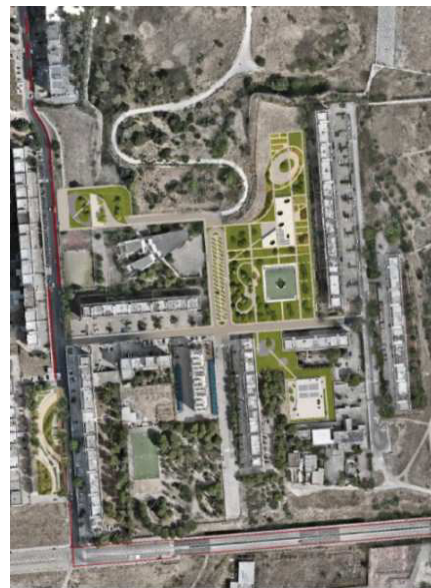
STRALCIO ORTOFOTO CON STATO DI PROGETTO
